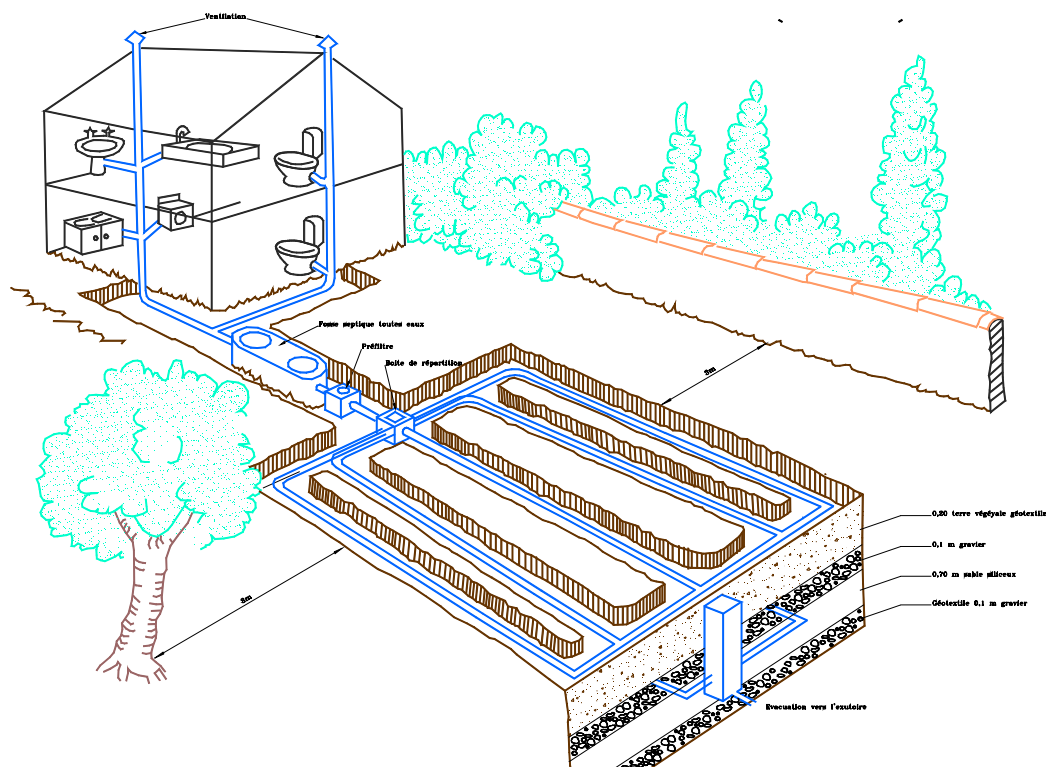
B : exemple d'une filière d'assainissement non collectif avec filtre vertical drainé
